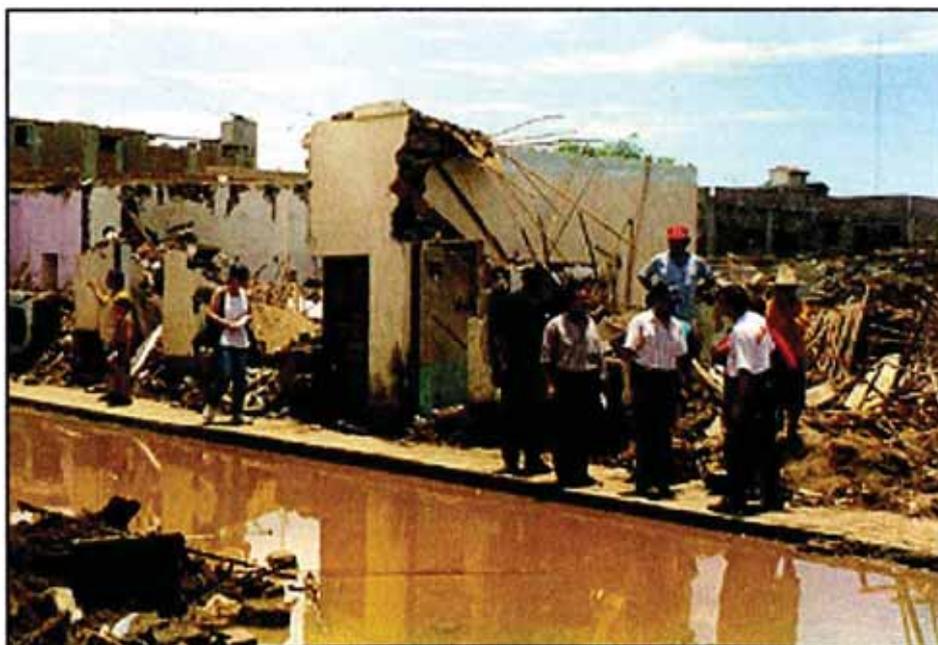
Calles Minería, Comercio y Huallaga, donde fueron destruidas 63 casas
